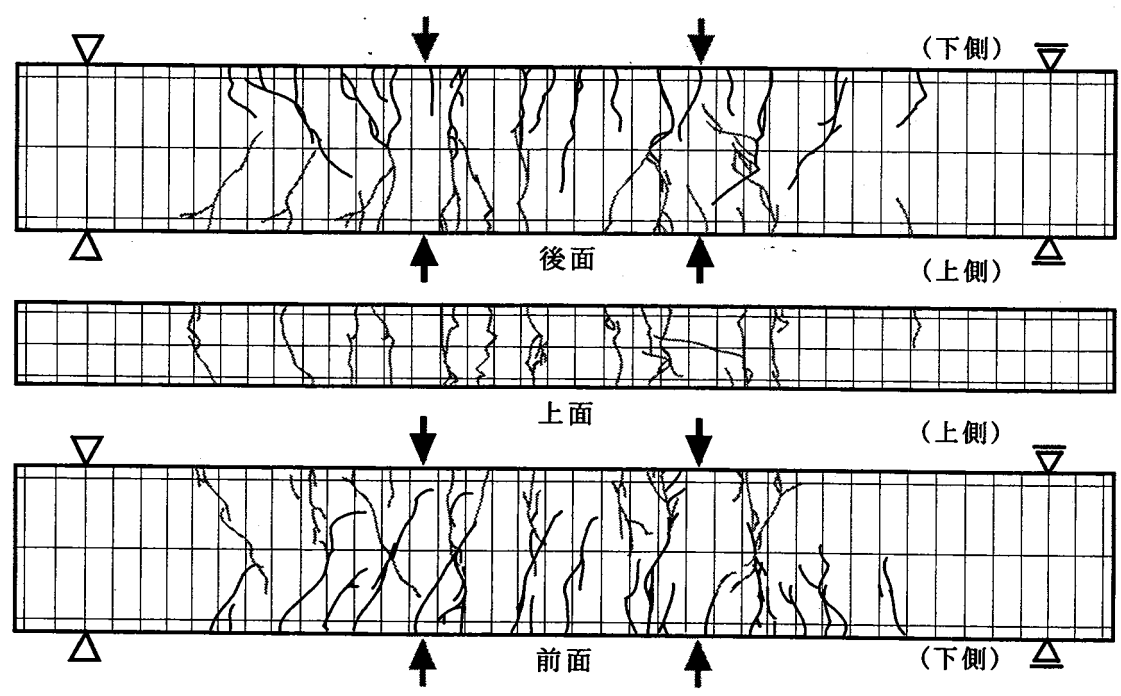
e) ひび割れ性状 [BS-2 ; R = 1/100rad.]
